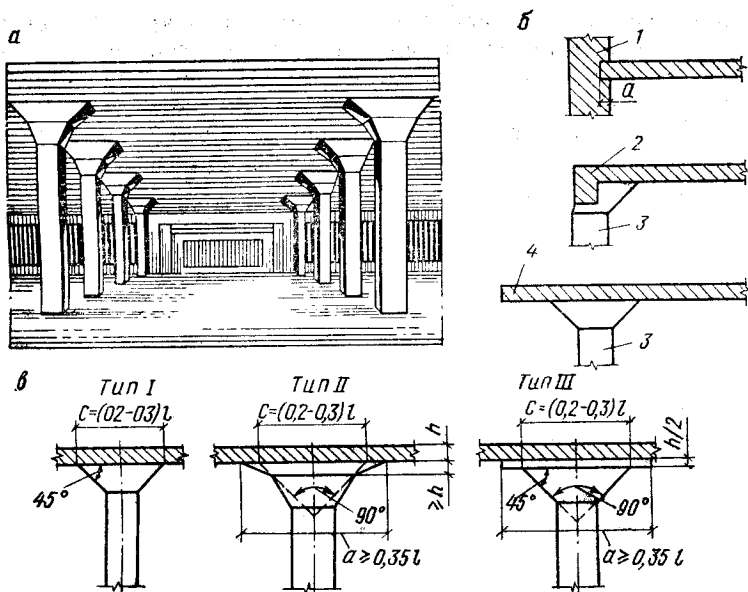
Конструкция безбалочного монолитного перекрытия
